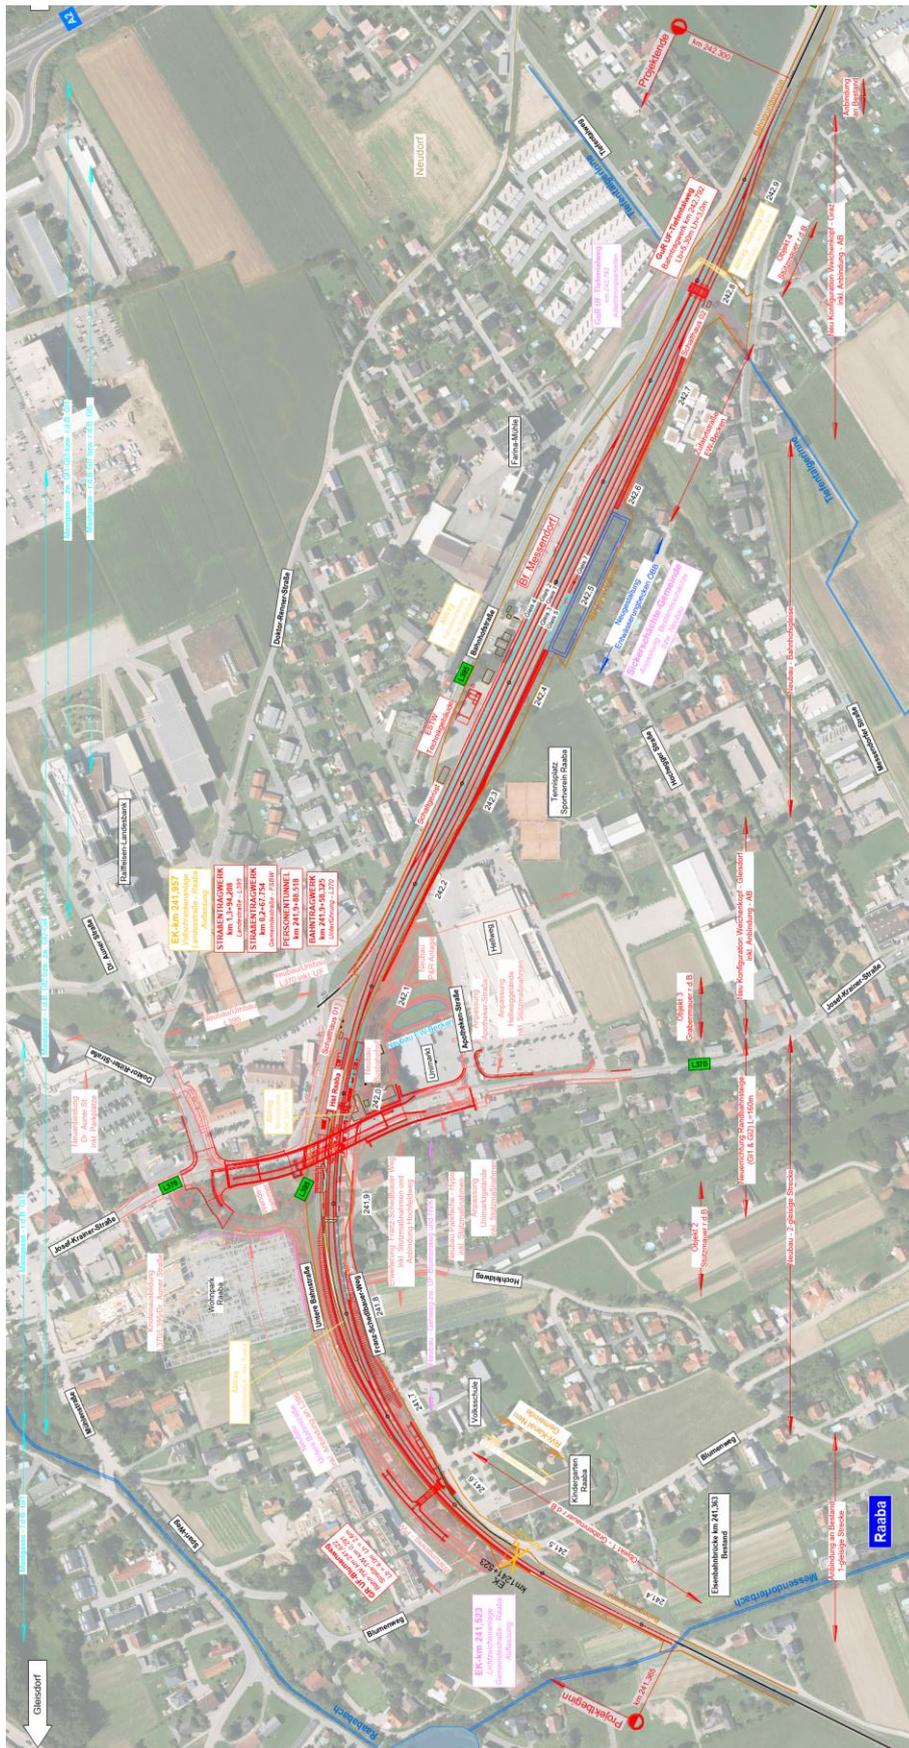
Übersichtlageplan - Planausschnitt (Quelle: integral ZT)
